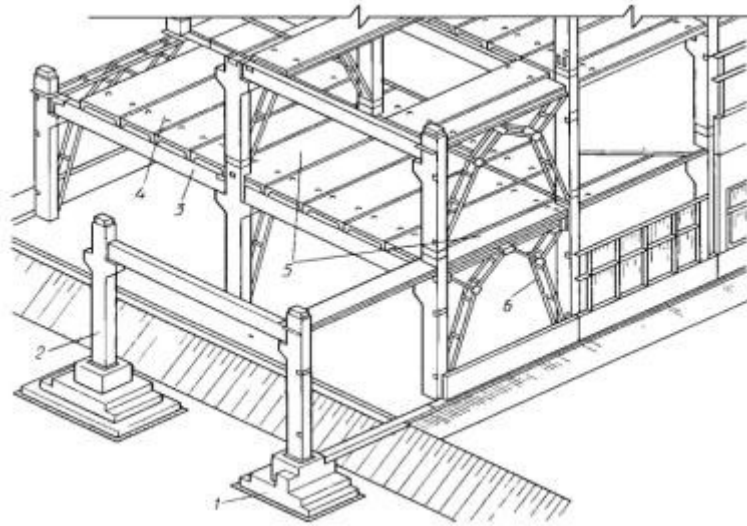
Железобетонный каркас многоэтажного промышленного здания.
